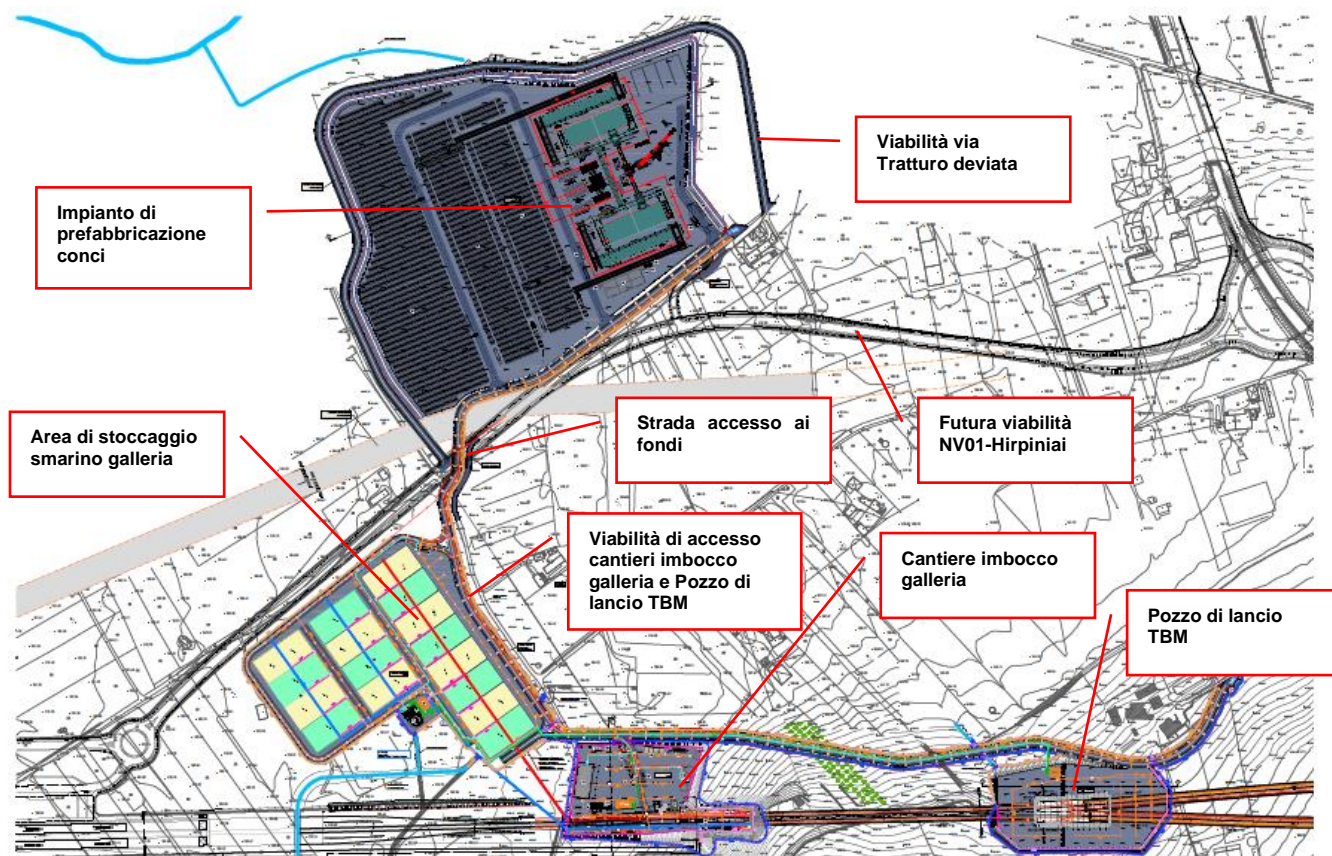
Imbocco lato Napoli: sistema di accesso ai cantieri operativi all'imbocco della galleria e al pozzo TBM
